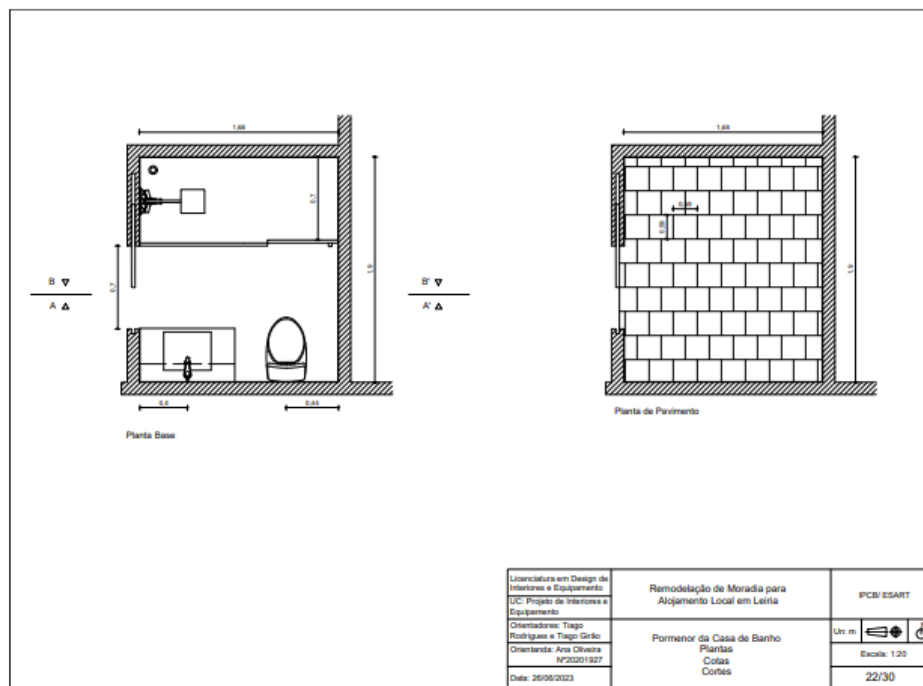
Plantas de Pormenorização, Casa de Banho, Piso 1 fonte a autora
